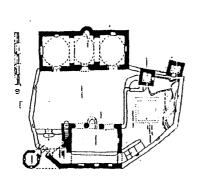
مسقط أفقى لمسجد البخارى (الحضرمي) في حيس اليمنية (عن الحداد) .
